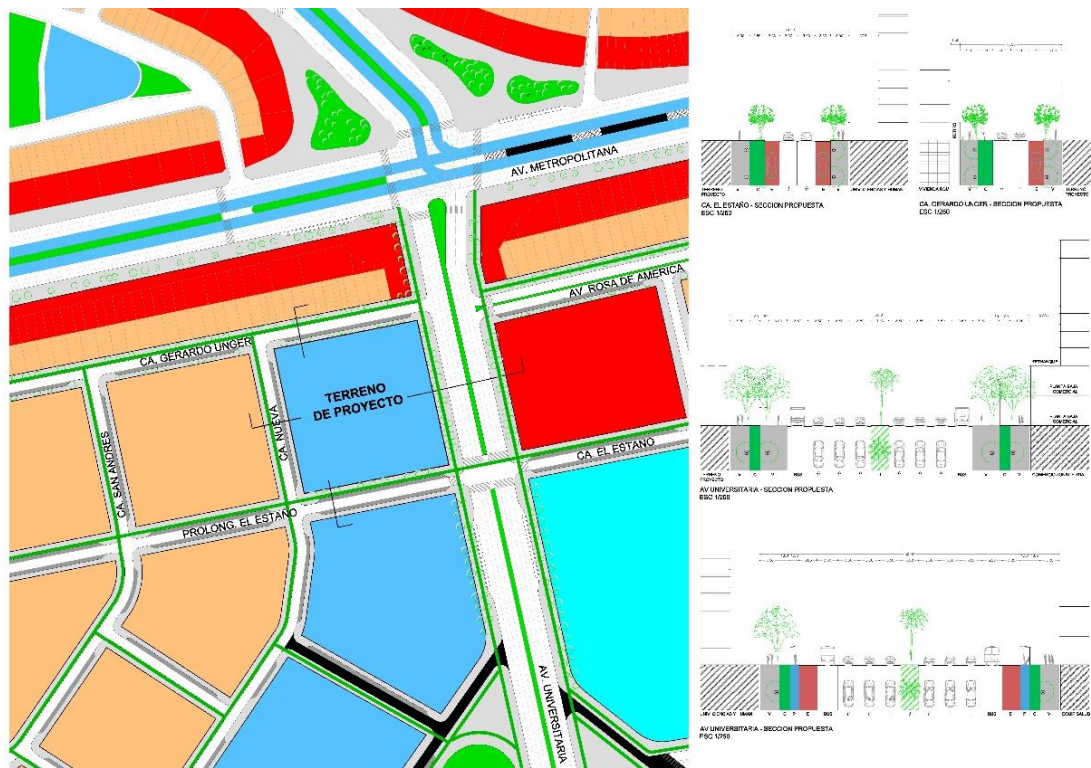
Terreno de proyecto en plan maestro y secciones de vía propuestas
